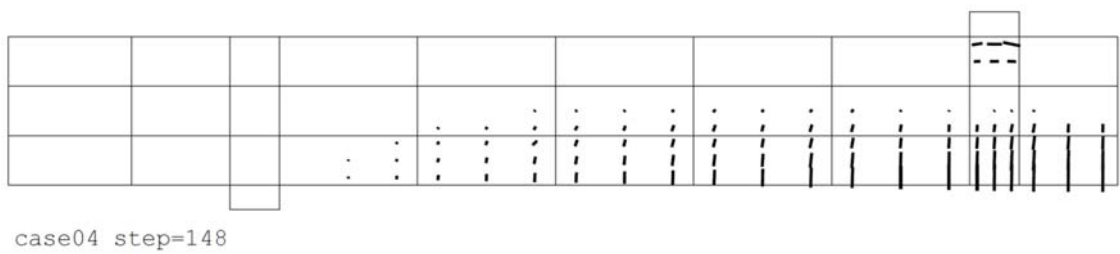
破壊時の変形及びひび割れ状態 (CaseNo. 4)
